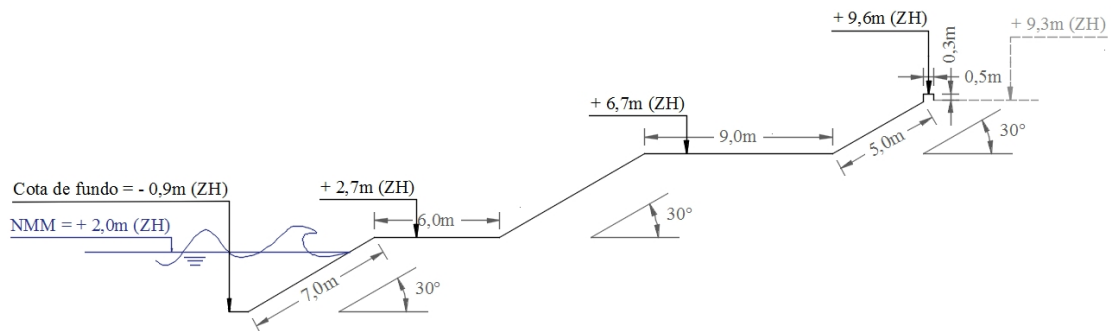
Corte transversal esquemático da obra longitudinal aderente de Cortegaça (DA4).
